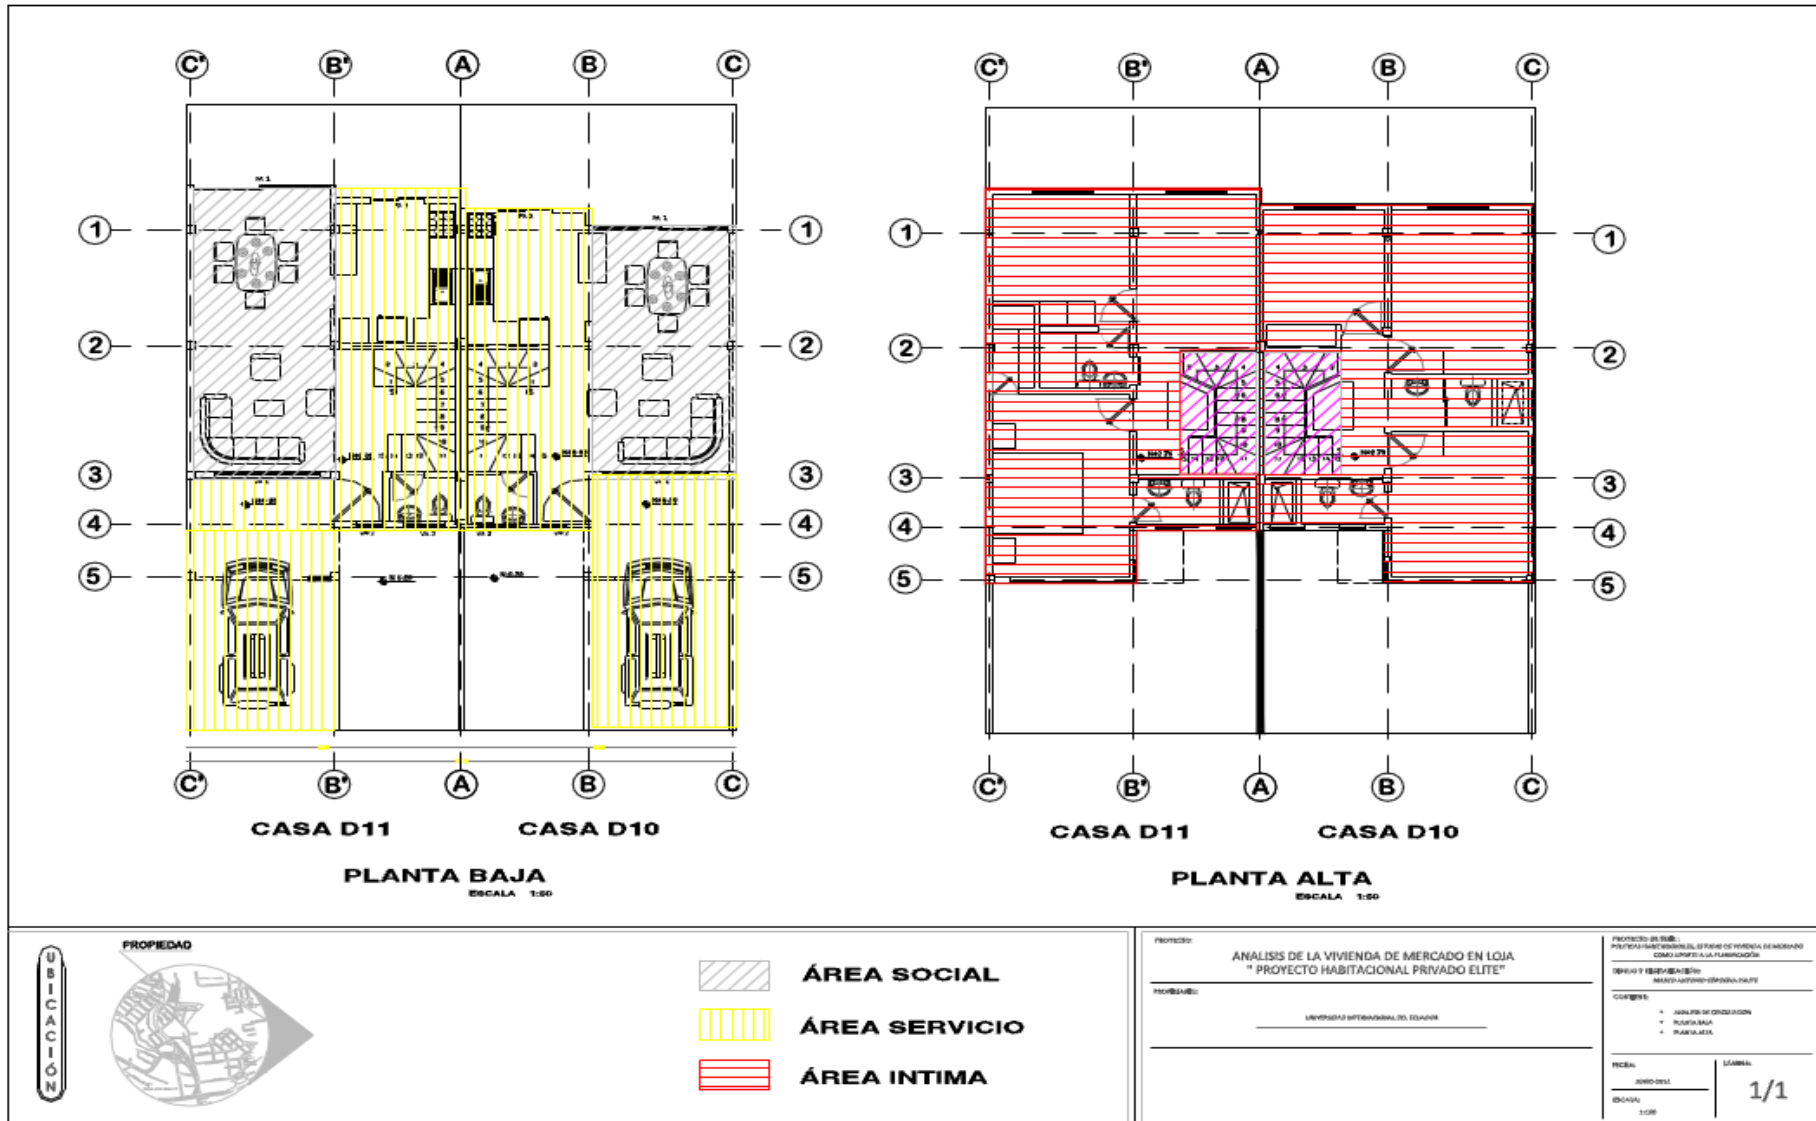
Áreas de las viviendas Plan Habitacional Élite
